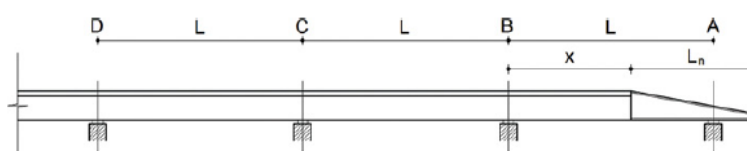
Fase 2, pico de lanzamiento apoyado en estribo o pila
